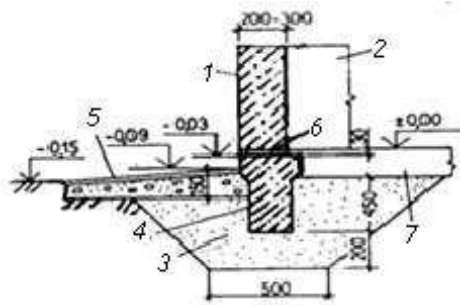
Цокольна частина стіни; 1 — панель поздовжньої стіни; 2 — колона; 3 — шлакова подушка; 4 — фундаментна балка; 5 — вимощення; 6 — гідроізоляція із цементного розчину; 7 — підлога.
